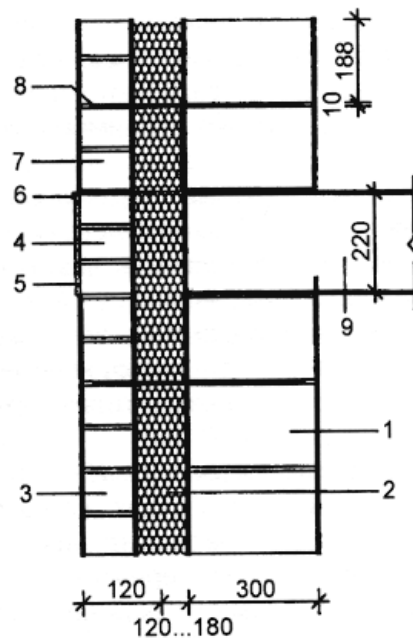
Трёхслойная стена с пенополистирольным утеплителем:
